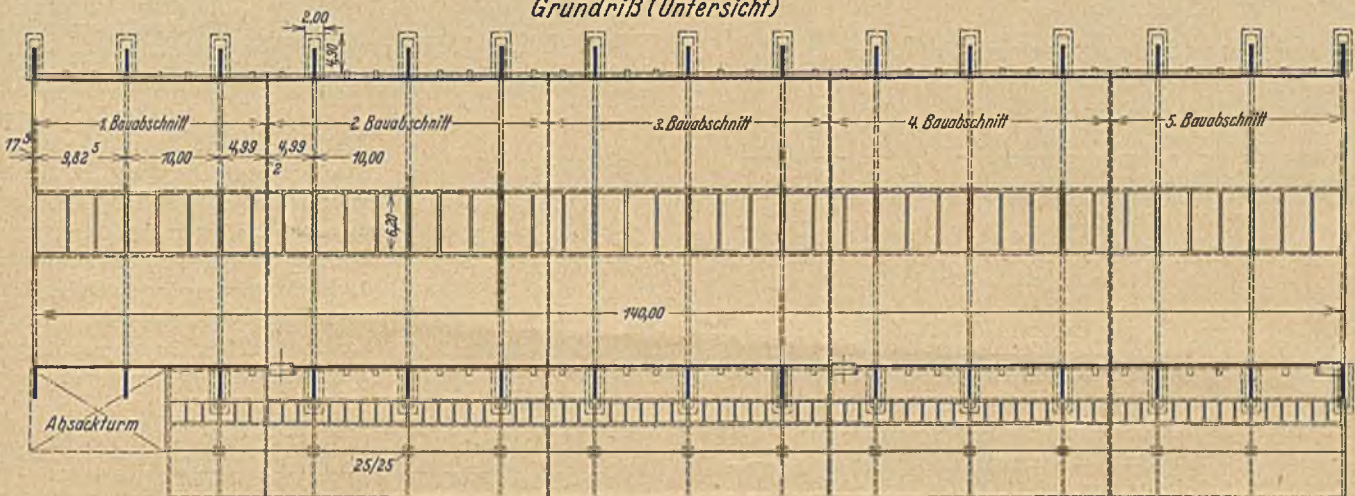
a. Salzlagerhalle Petfürdő, Grundriß.
